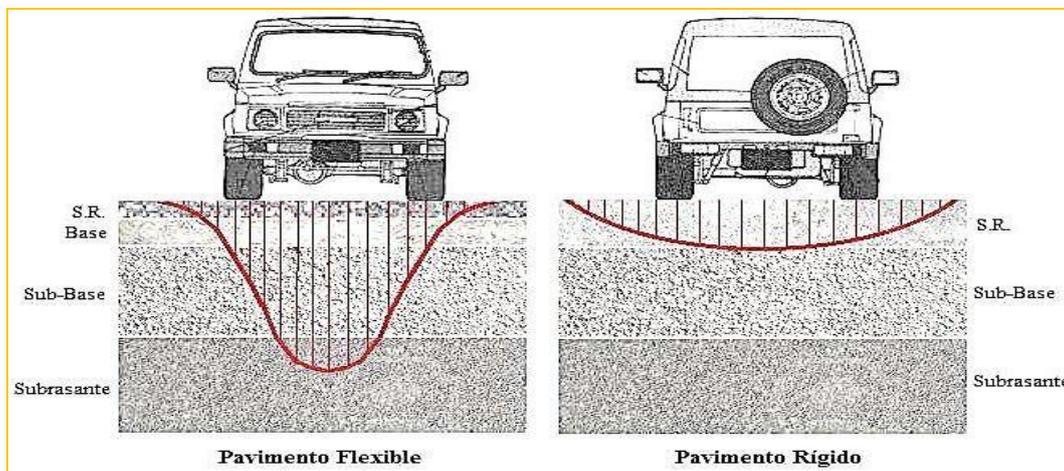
Esquema del Comportamiento de Pavimentos Flexibles y Rígidos
